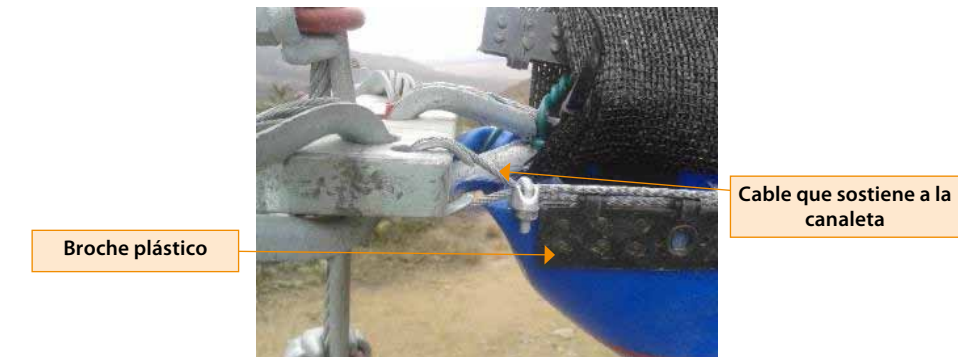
Estructura soportante de la canaleta (Proyecto Atrapanieblas).
